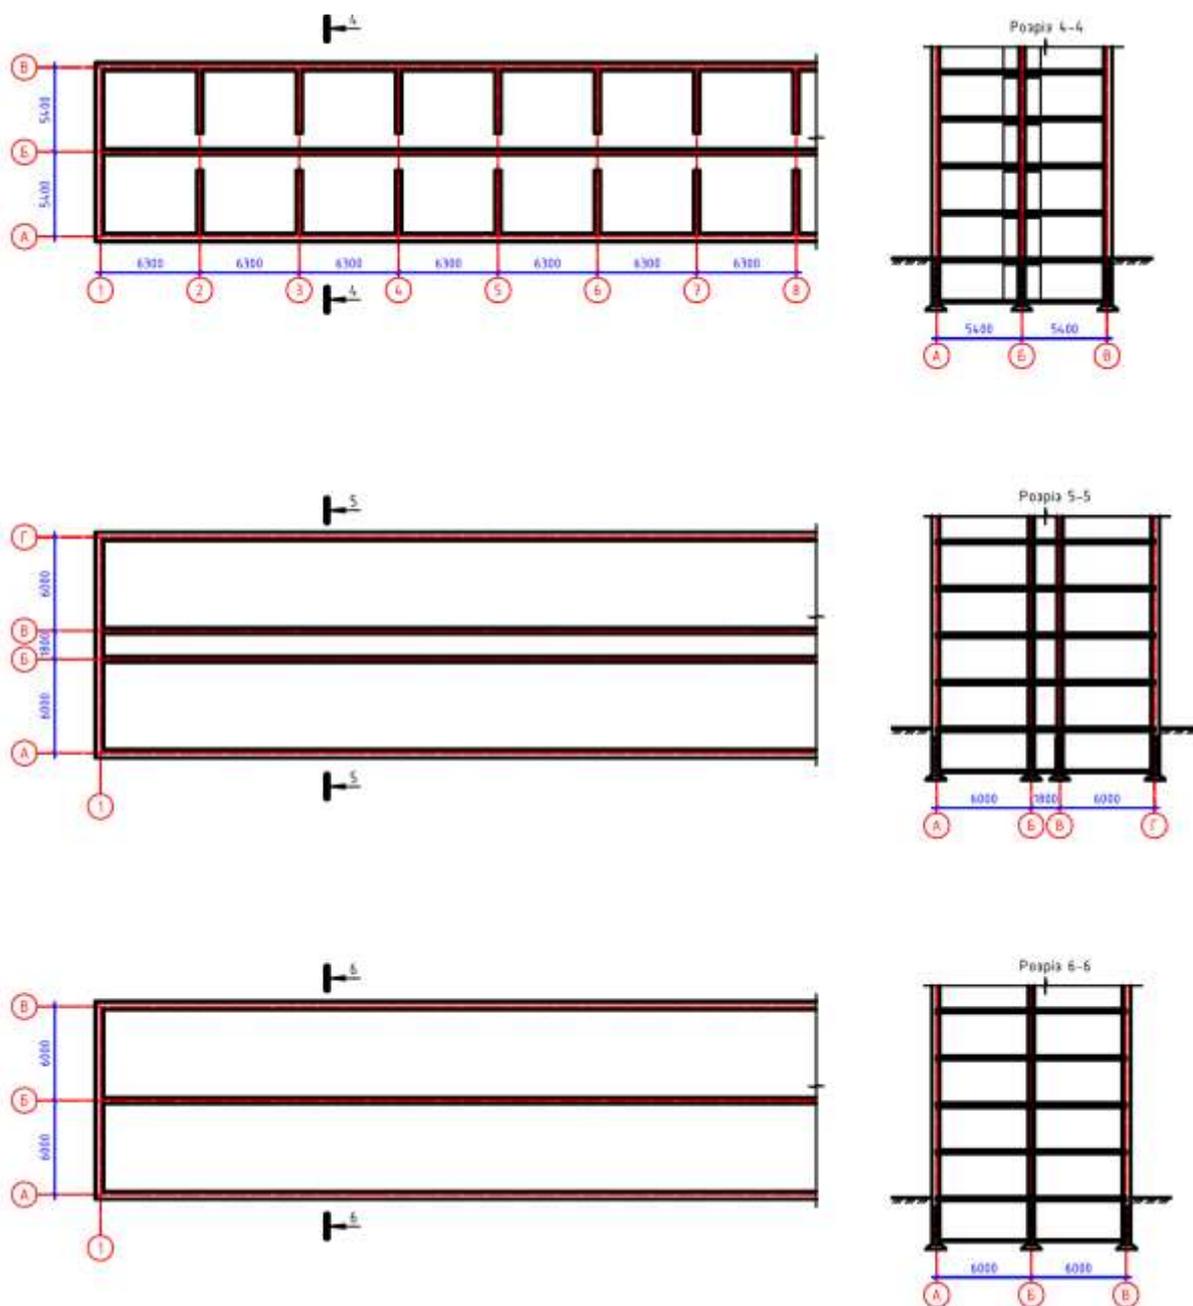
Об'ємно-планувальні схеми сховищ житлових будівель
